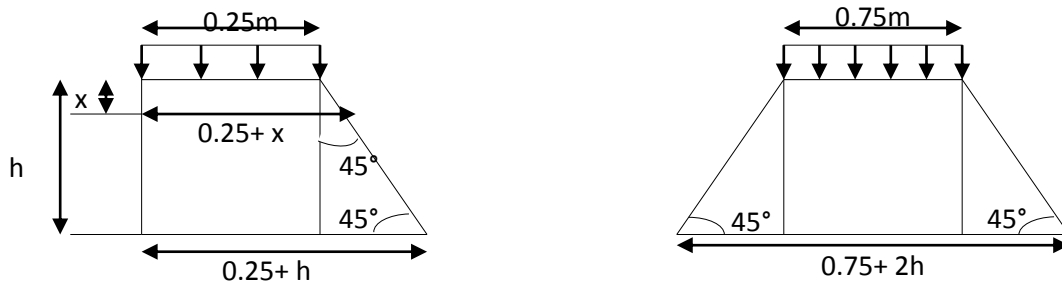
Poussée de la charge locale située en arrière du mur.
